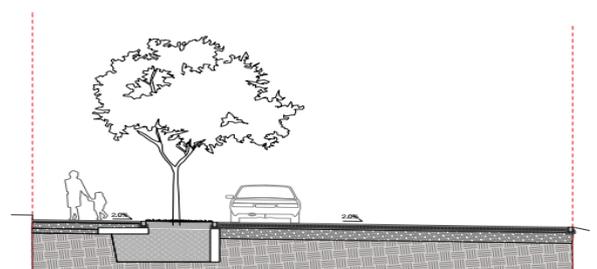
coupe type trottoir-allée d'arbre-stationnement latéral-chaussée
